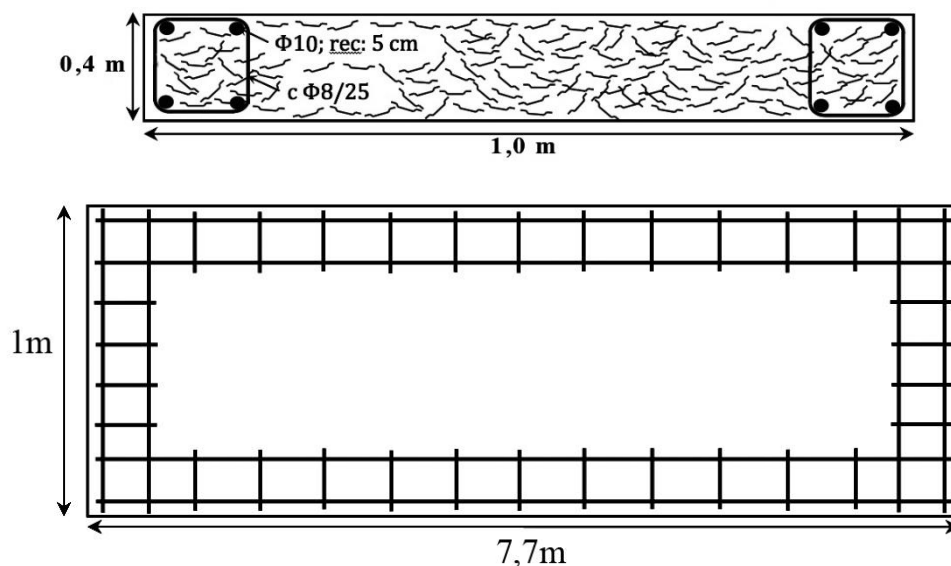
Sección transversal y planta de una dovela armada con una configuración mixta, consistente en un zuncho perimetral y una matriz de HRF (Guillamón, 2013).
